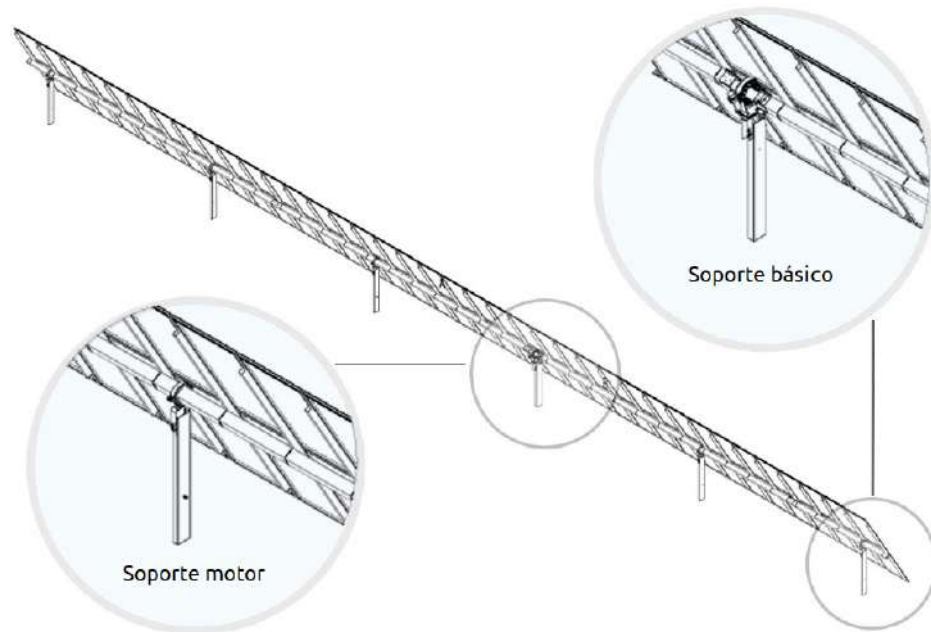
Perfiles de cimentación estructura seguidor tipo
